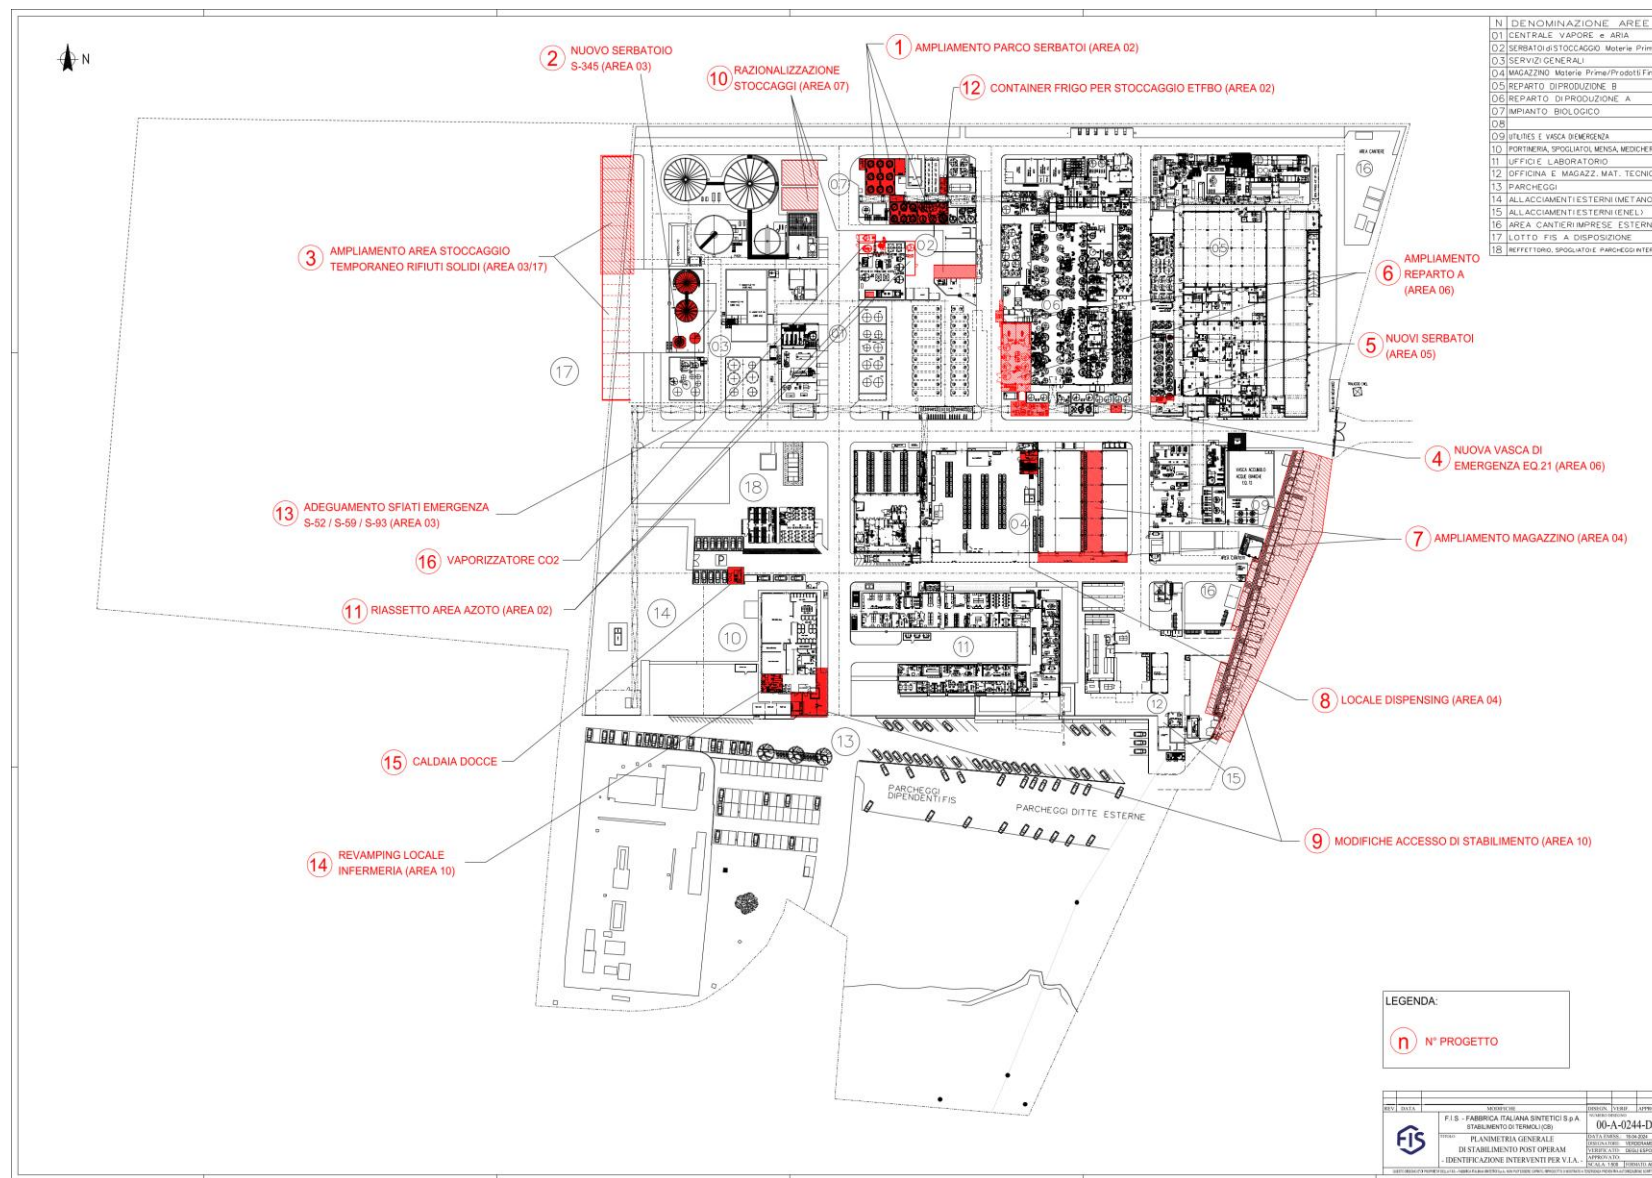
planimetria generale di stabilimento con indicazione delle aree di intervento: assetto "post operam"
